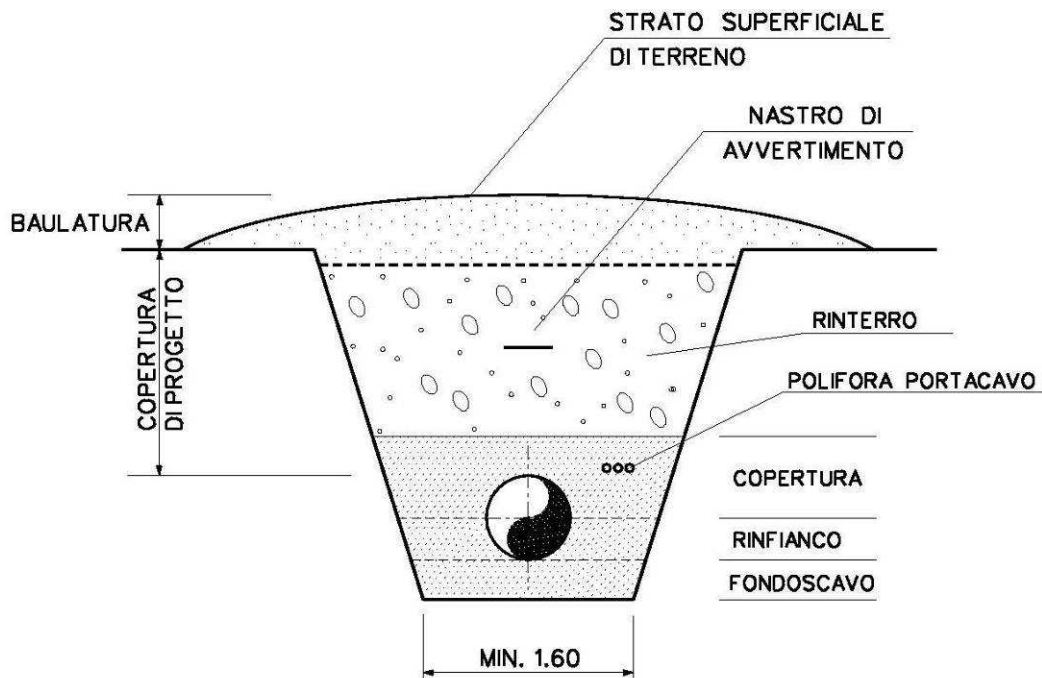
Sezione tipica del ricoprimento della trincea.
